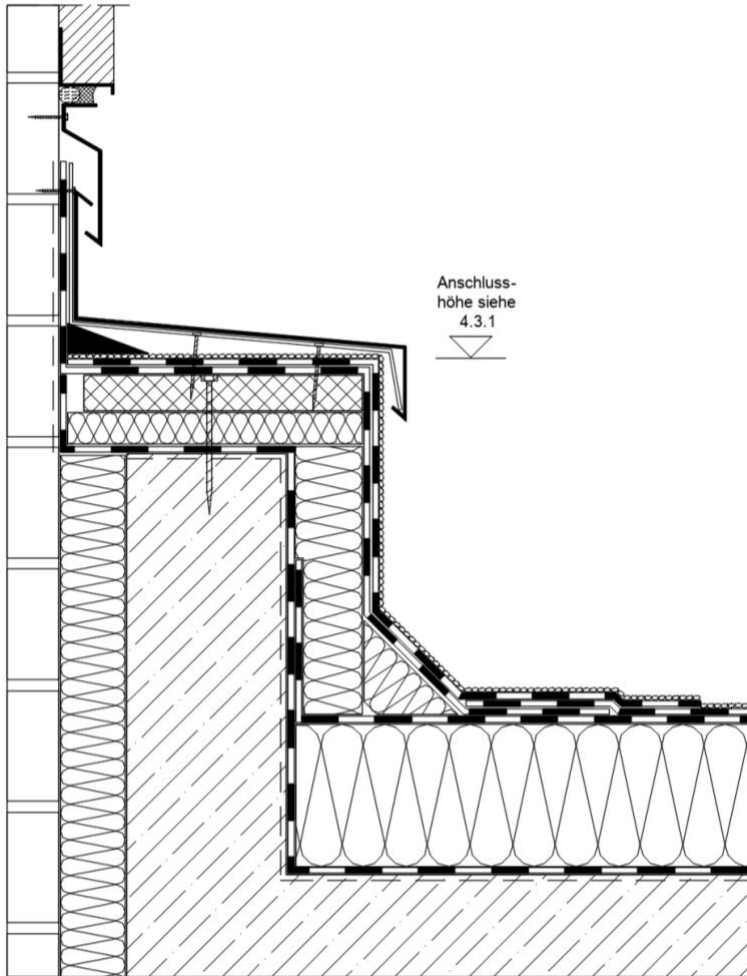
Beweglicher Wandanschluss mit Betonaufkantung – Ausführung mit Bitumenbahnen
